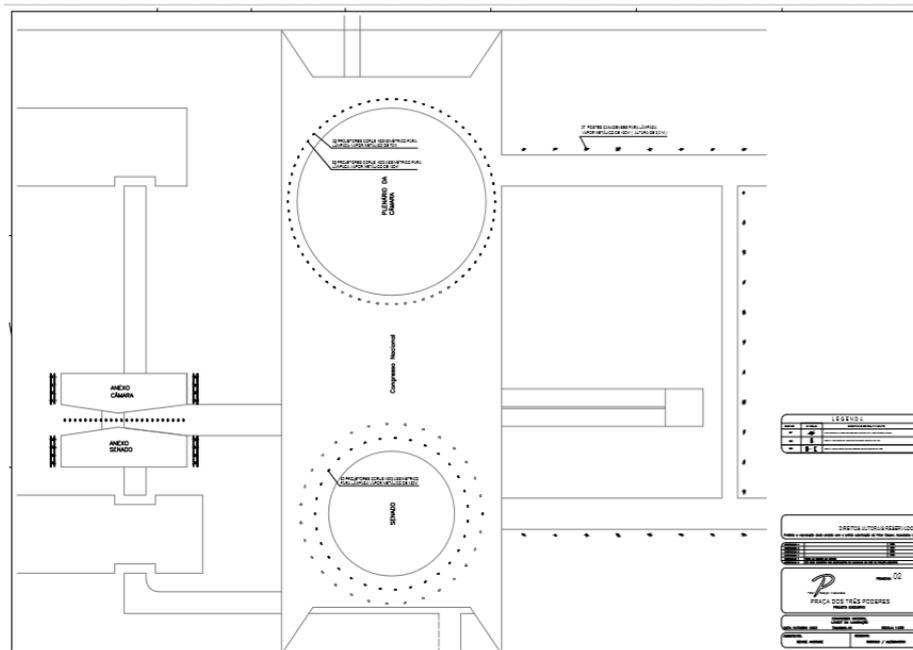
Planta luminotécnica do Congresso Nacional¹⁰⁹
